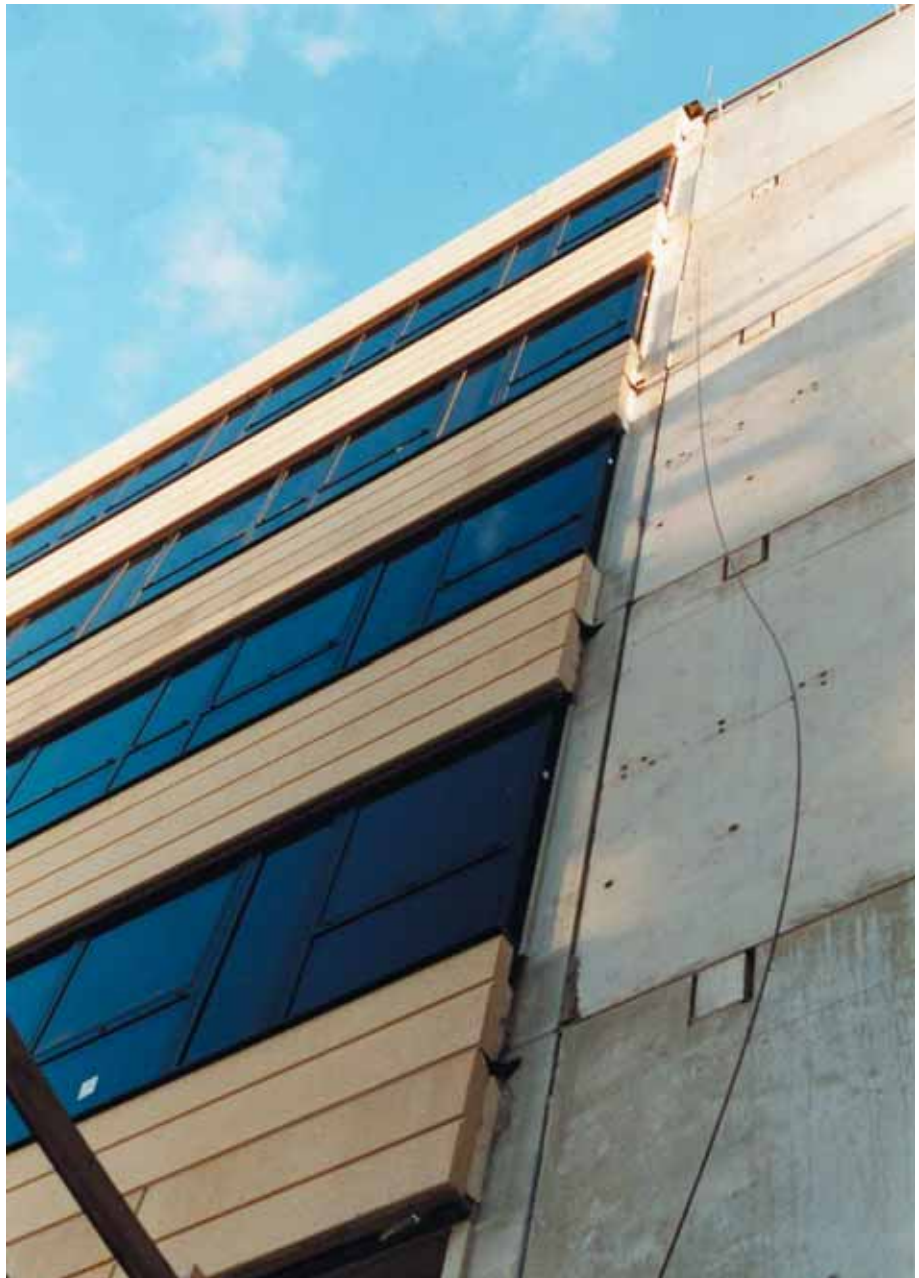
Een deel van dit gebouw is met sandwichelementen opgebouwd. Aan de rechterzijde zijn dragende binnenspouwbladen toegepast, waarop later isolatie en afwerking wordt aangebracht.
